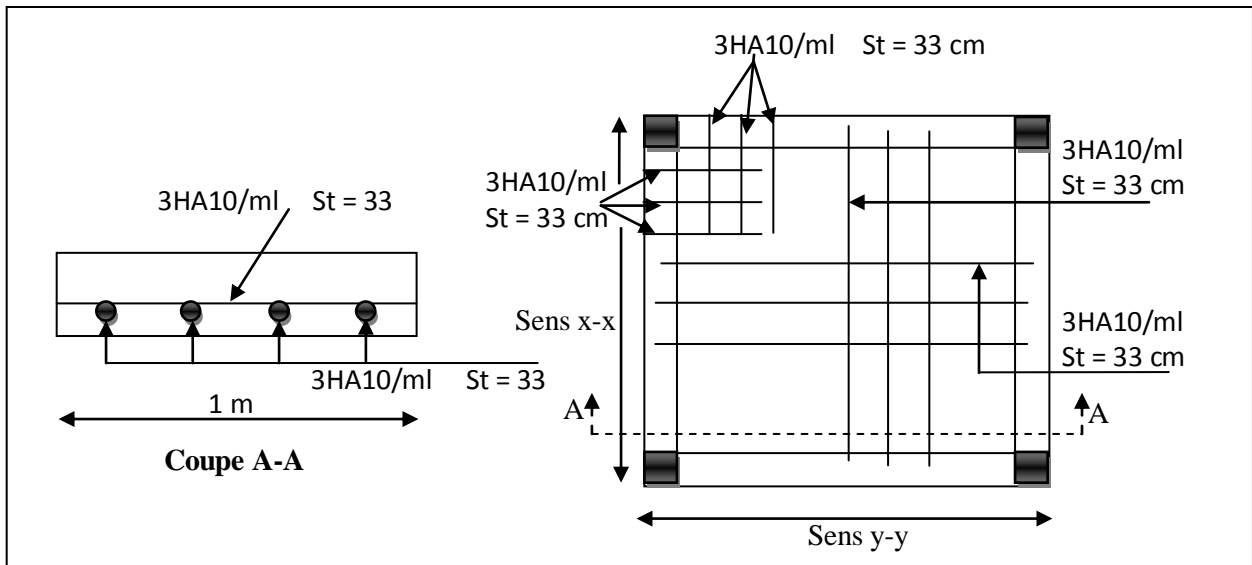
Schéma de ferrailage la dalle pleine au-dessous de l'ascenseur
